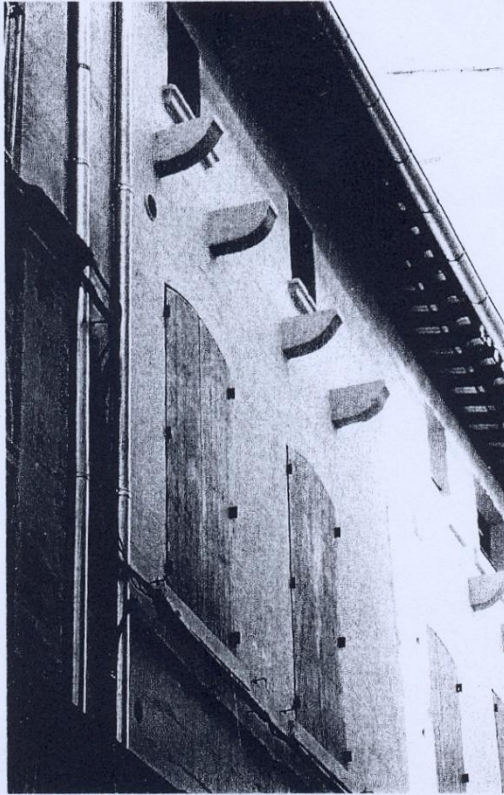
Beaucaire. Maison. Poutres de pierre en saillie sur la partie supérieure de la façade.
